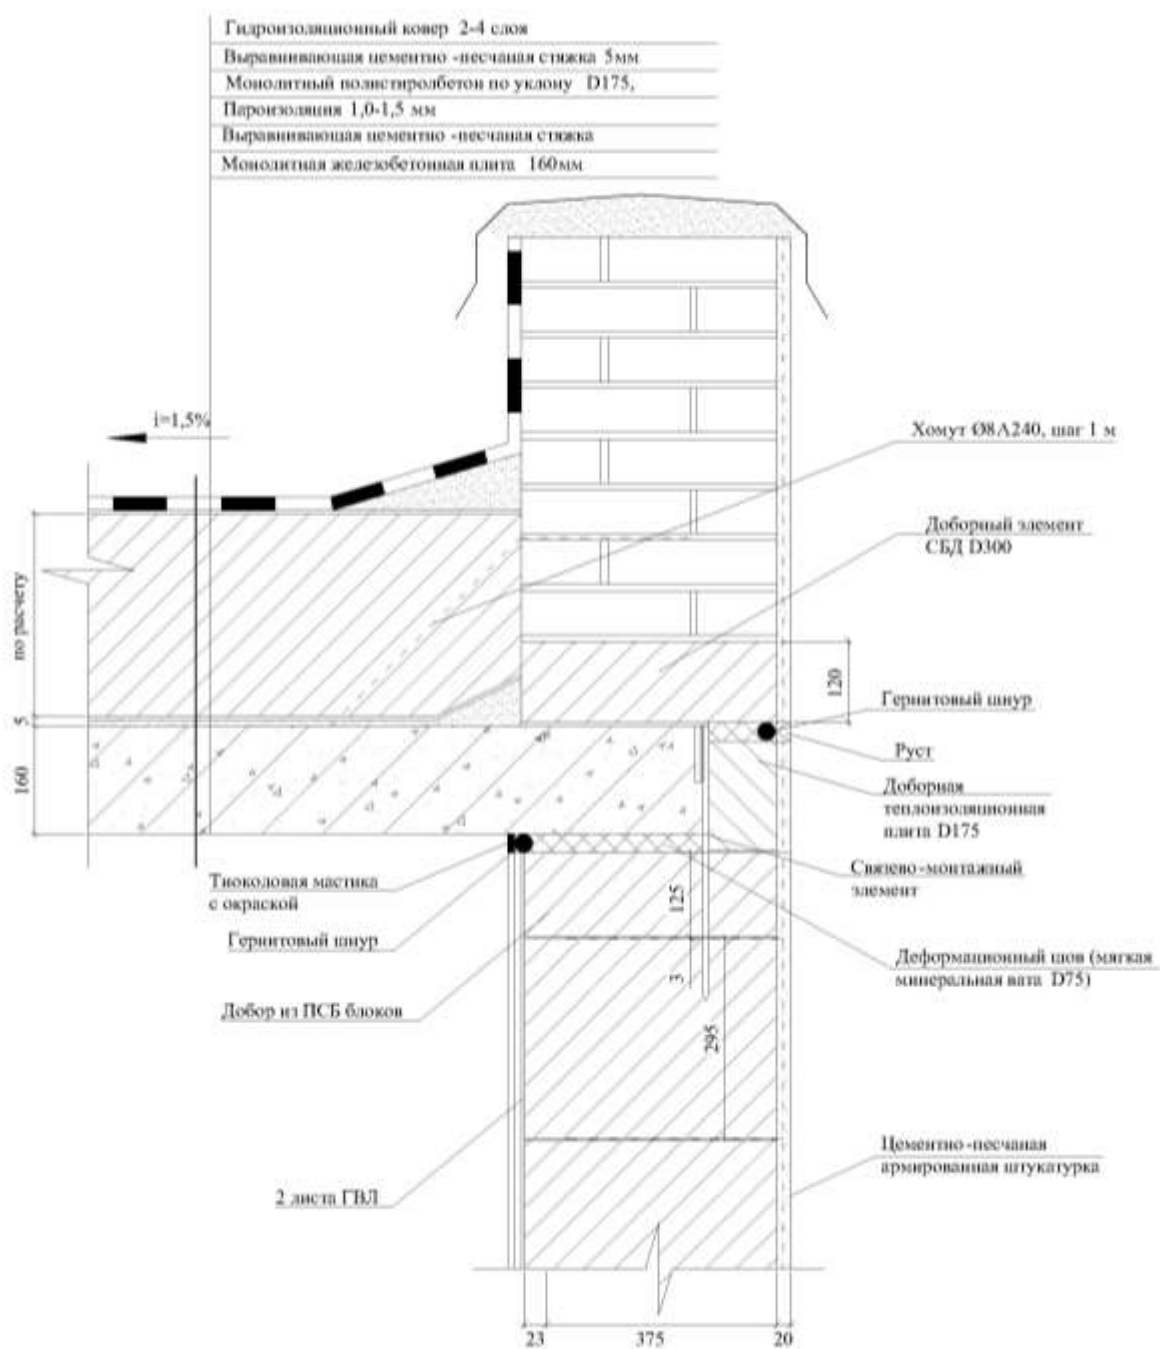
Утепление покрытия здания с использованием монолитного полистиролбетона
